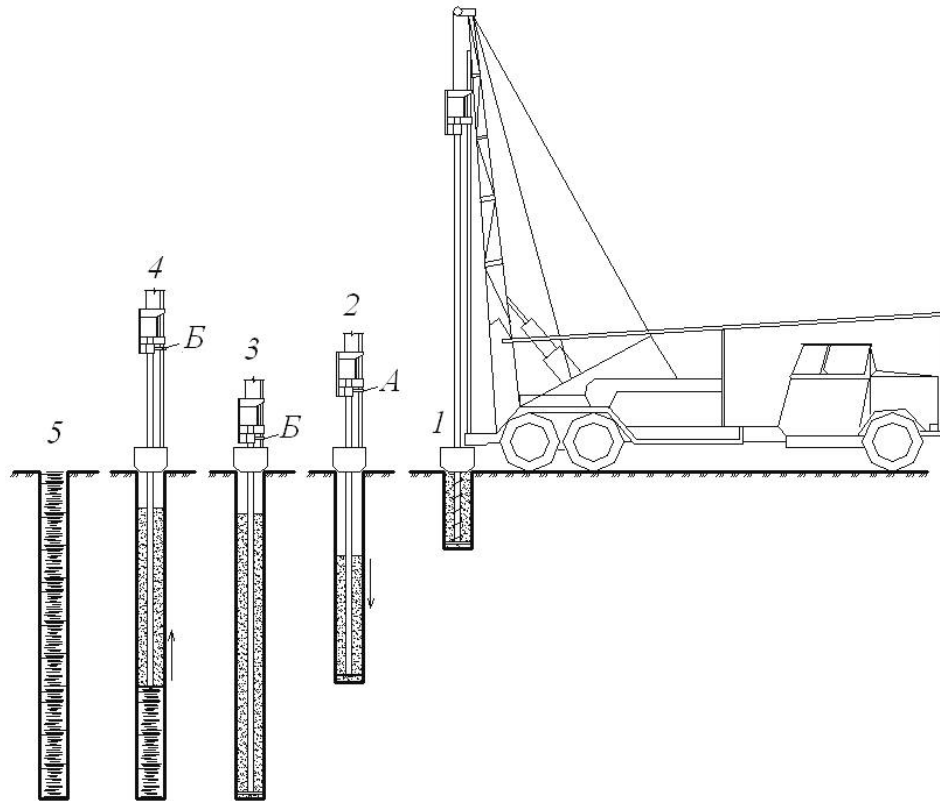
Технологічна схема влаштування ґрунтоцементних палей в лесових ґрунтах: 1 – влаштування приямка; 2 – заглиблення бурозмішувача та перевід ґрунту в текучий стан; 3 – порожнина заповнена ґрунтом текучої консистенції; 4 – піднімання бурозмішувача та подача водоцементного розчину; 5 – готова палея: А – вода; Б – розчин.
